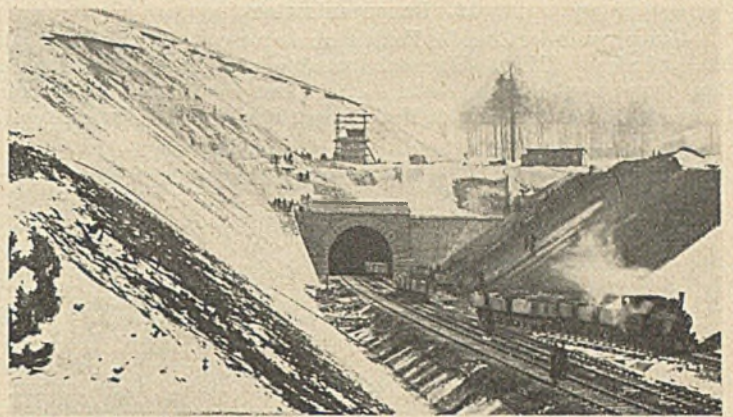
Das Westportal nebst dem noch eingerüsteten Entlüftungsturm.
